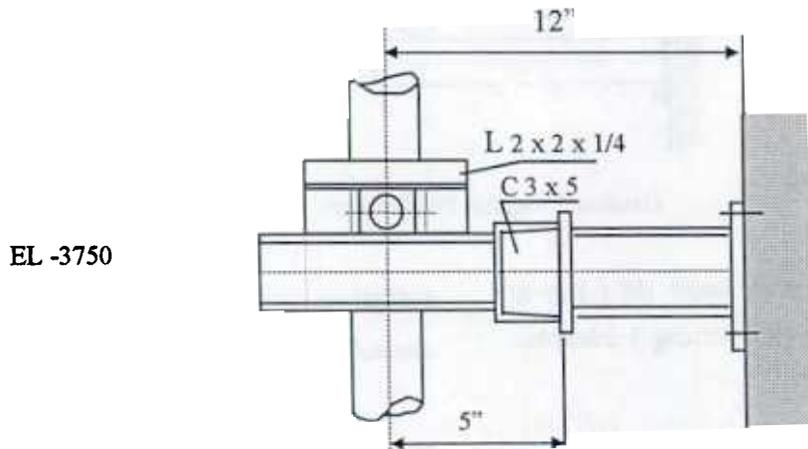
c. Potongan Isometrik Pipa B310-1''
